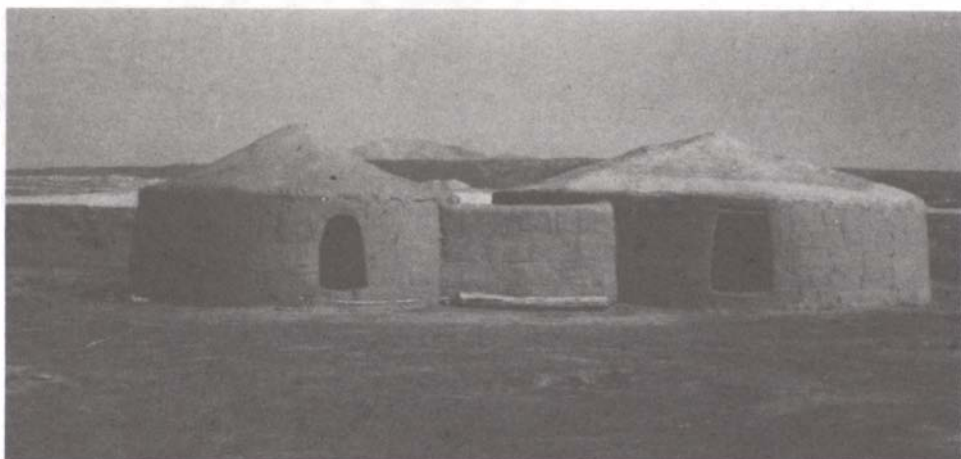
Polígono de Ensayos construido a semejanza de las estructuras originales N°s 2 y 3.
